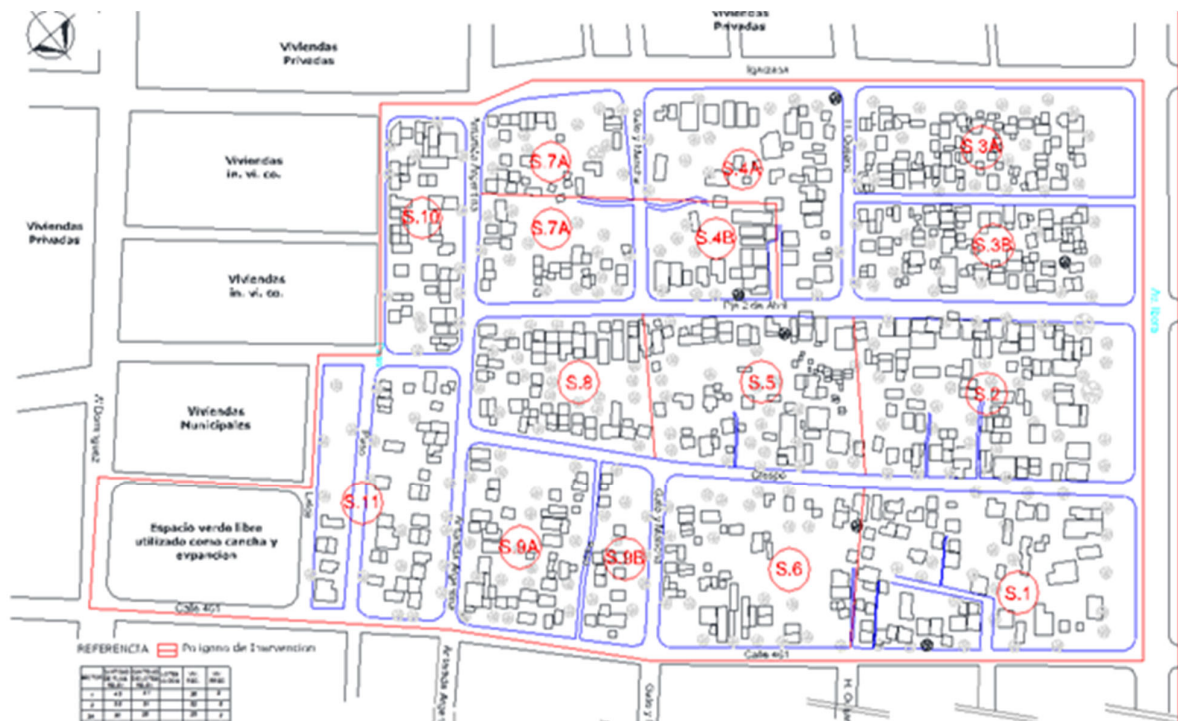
Plano de sectores del polígono de intervención (Plano N°13 en doc. PEI )
